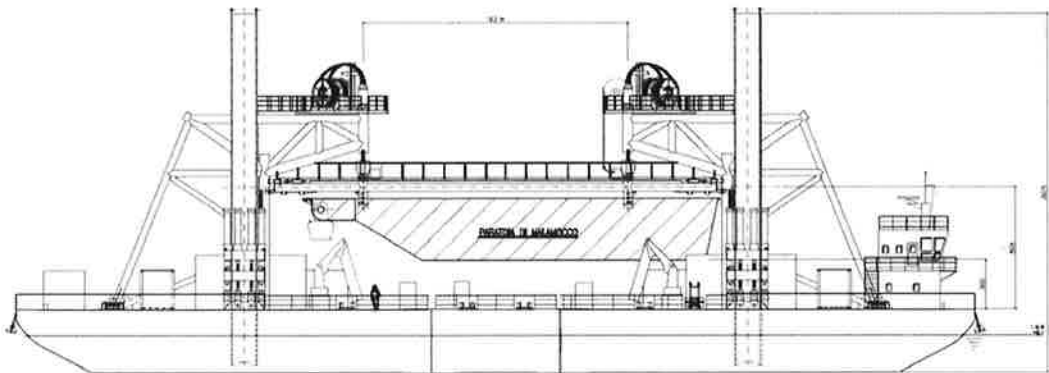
JACK-UP – VISTA LATERALE IN CONFIGURAZIONE LUNGA
